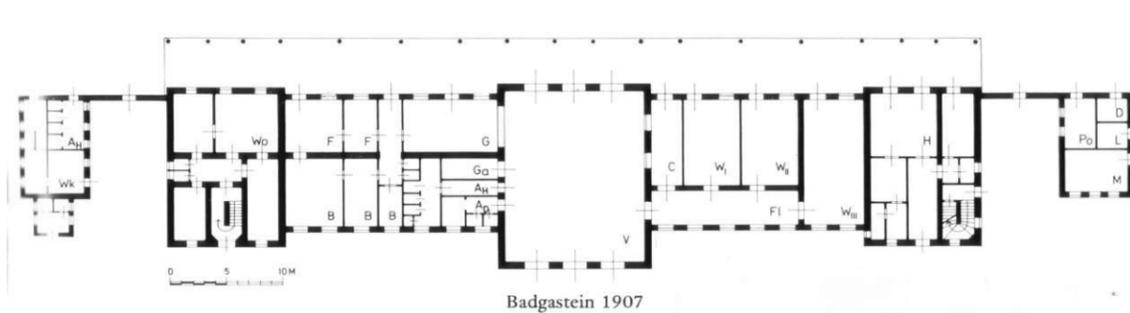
Bahnhof in Bad Gastein, Grundriss, 1907
